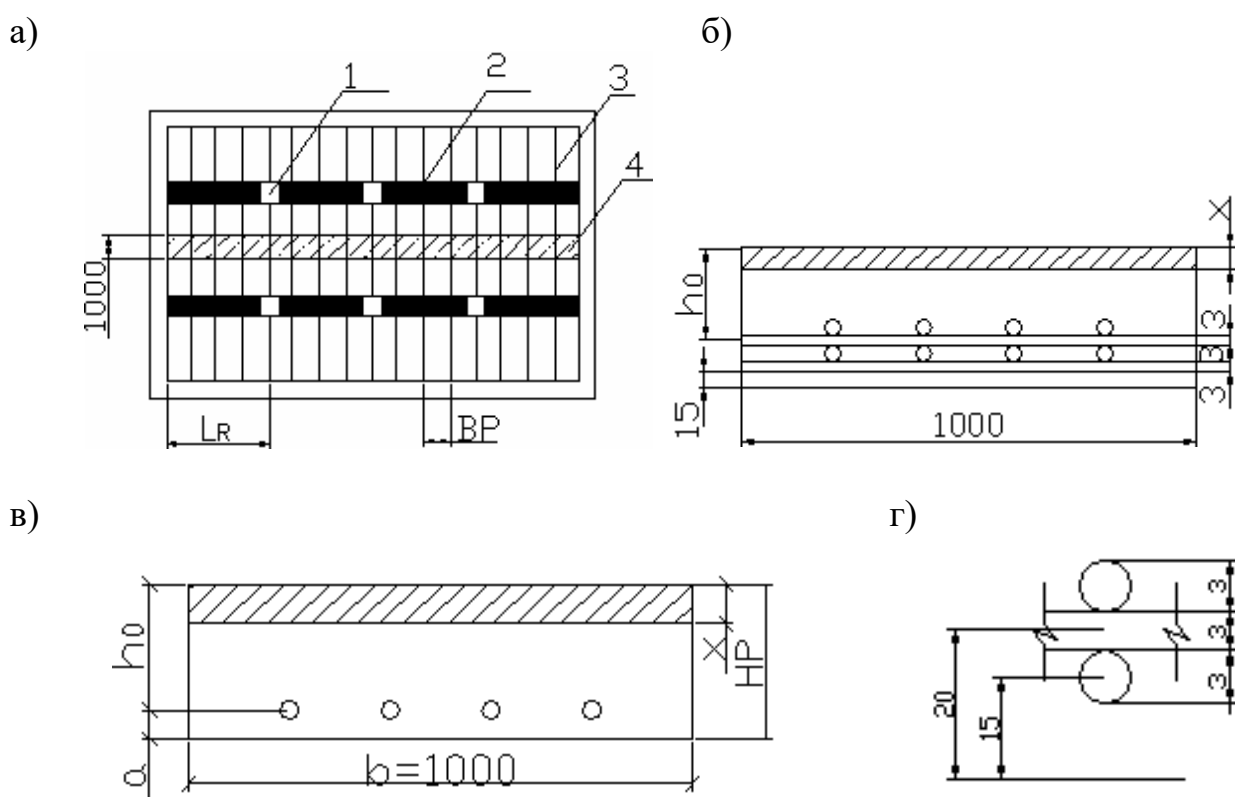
Сечение плиты в расчётной точке 1(а); План перекрытия (б): 1- колонна, 2-балка, 3-второстепенная балка, 4-вырезанная полоса шириной 1 метр. Сечение плиты в расчётной точке 2(в); Защитный слой арматуры (г).
